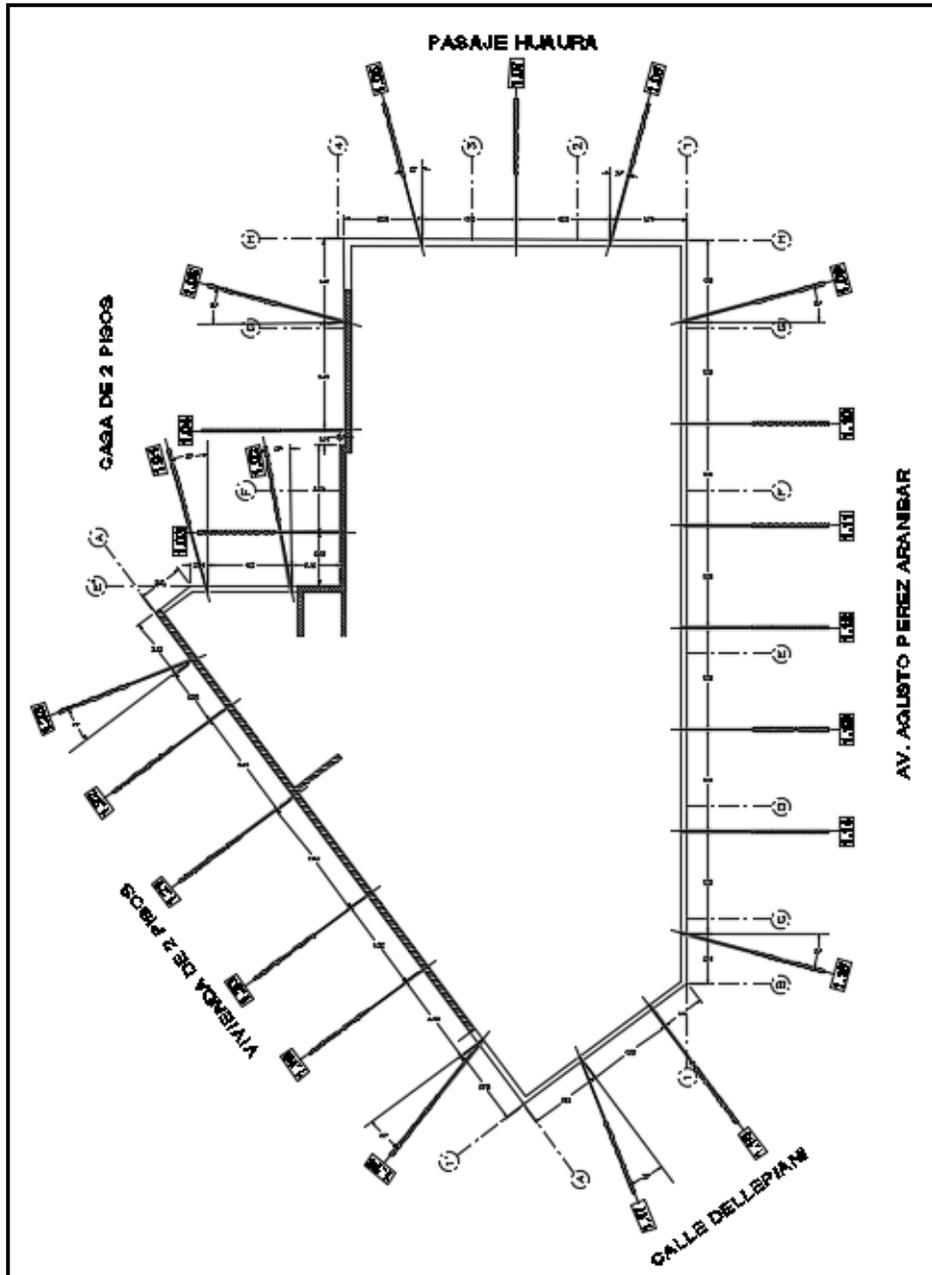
Plano en planta obra 2: Edificio Crossland – Muro anclado.
